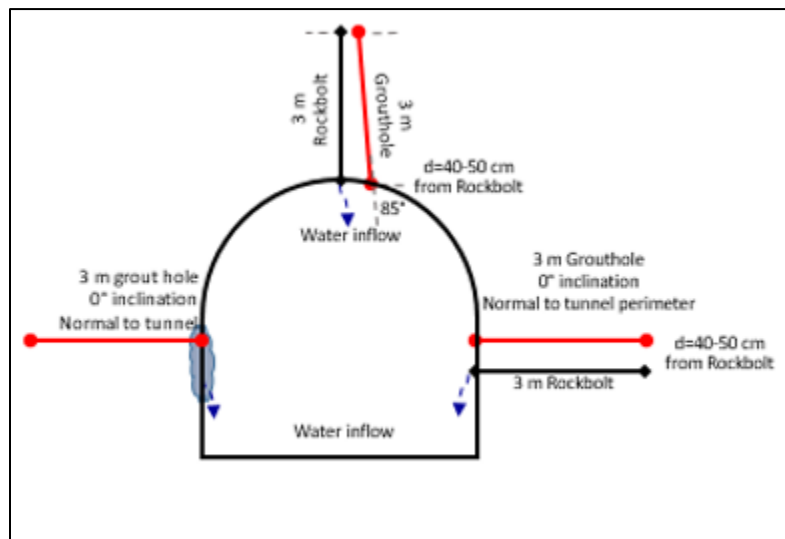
Ejemplo de patrón de diseño de spot-grouting complementario para Drill & Blast.
